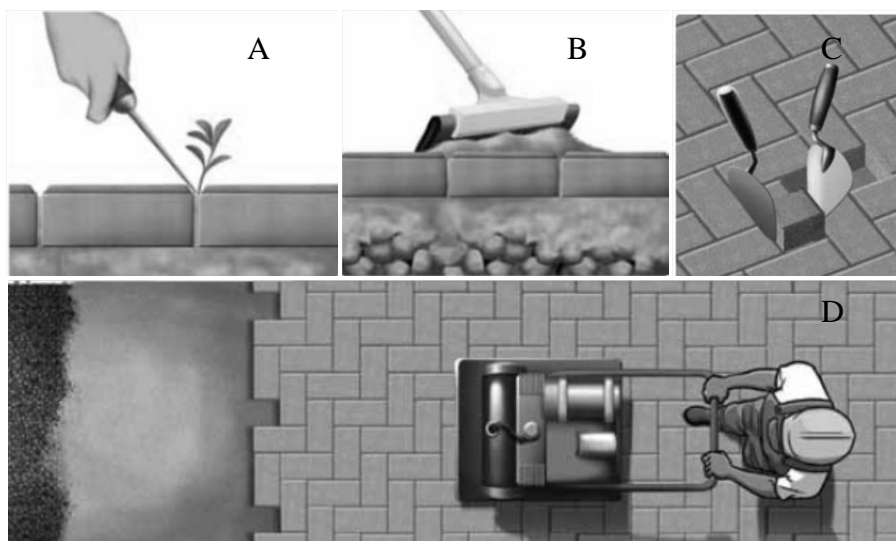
1 - Operações de conservação de pavimento de blocos
